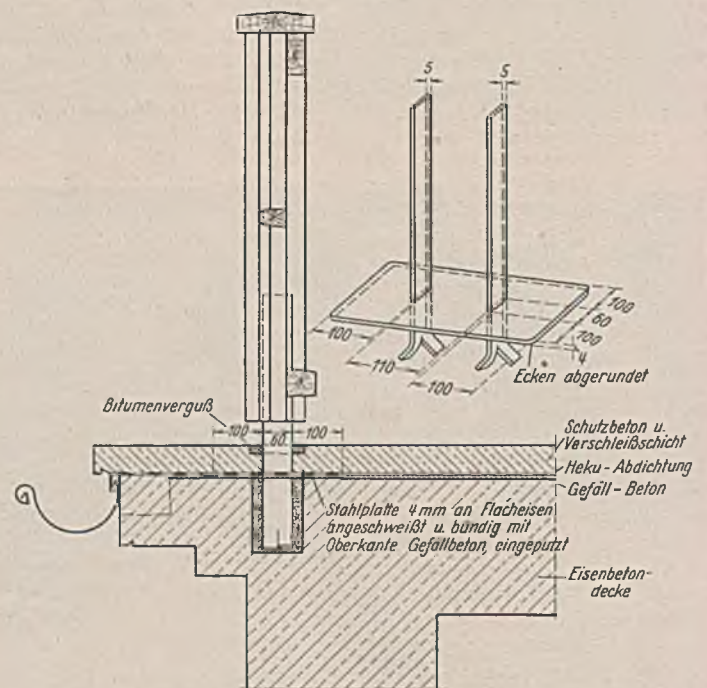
Anschlußverbindung einer Blechbanddichtung an die Wasser- rinne (Falzverbindung) einer Terrasse und Befestigungseisen für Holz- geländer (Klebenaht auf angeschweißter Eisenplatte).
